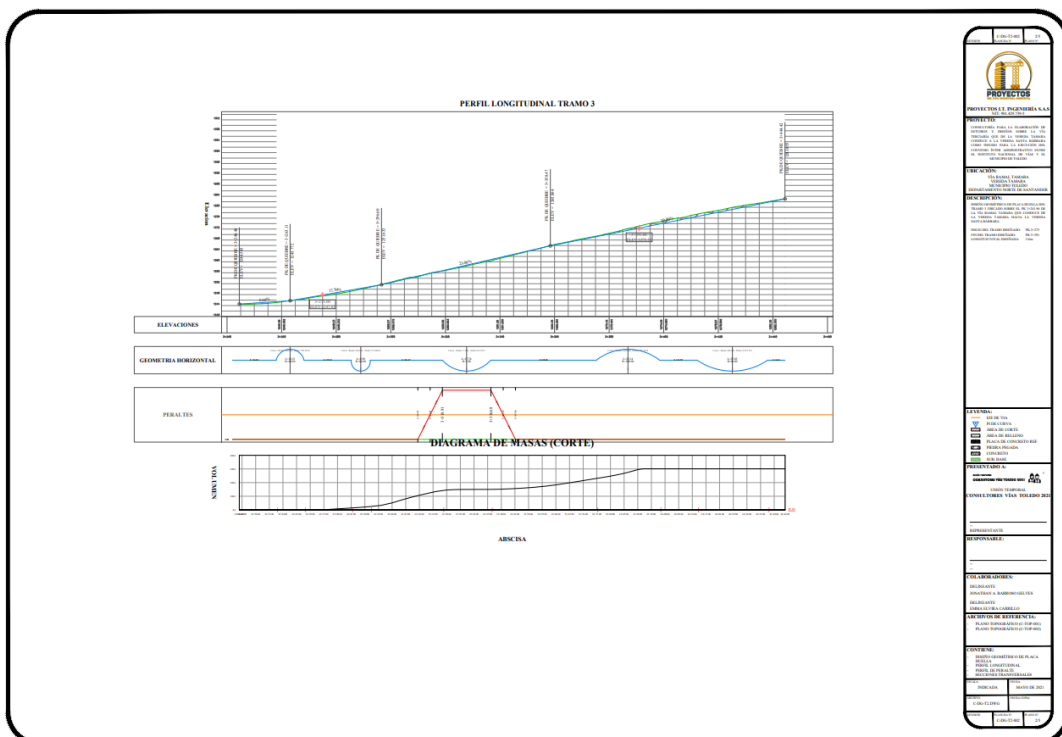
Plano de perfil longitudinal fuente (propia).
